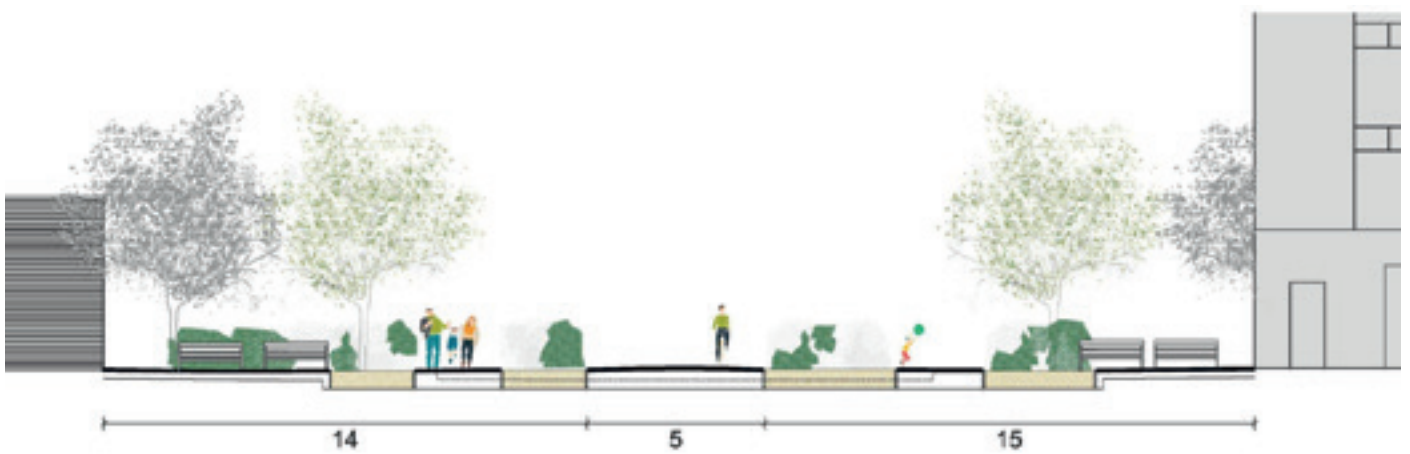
Secció del Carrer Sancho de Àvila. Font Ajuntament de Barcelona.
